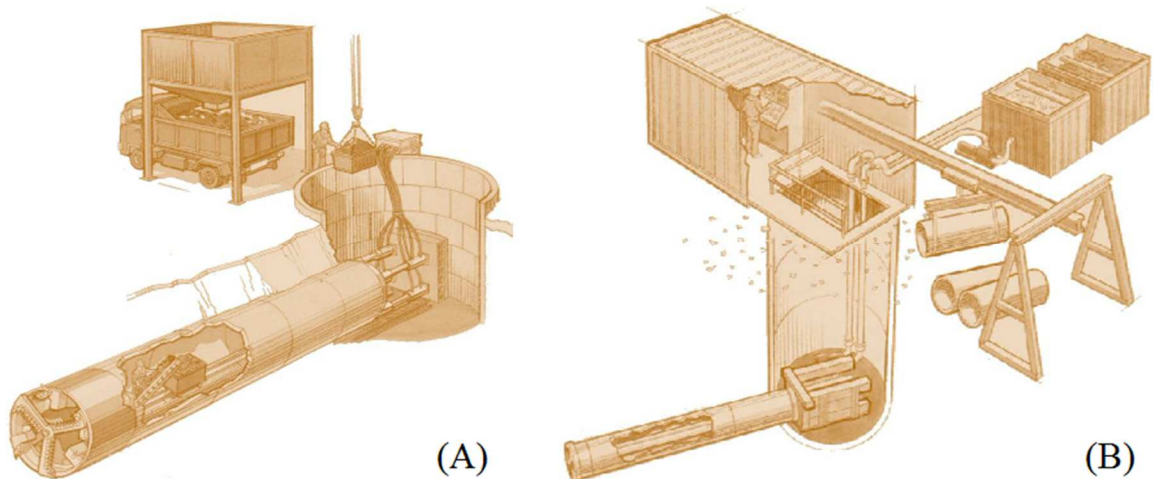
Remoção do material por sistema de rosca (A); Remoção do material por bombeamento de fluido (B)
